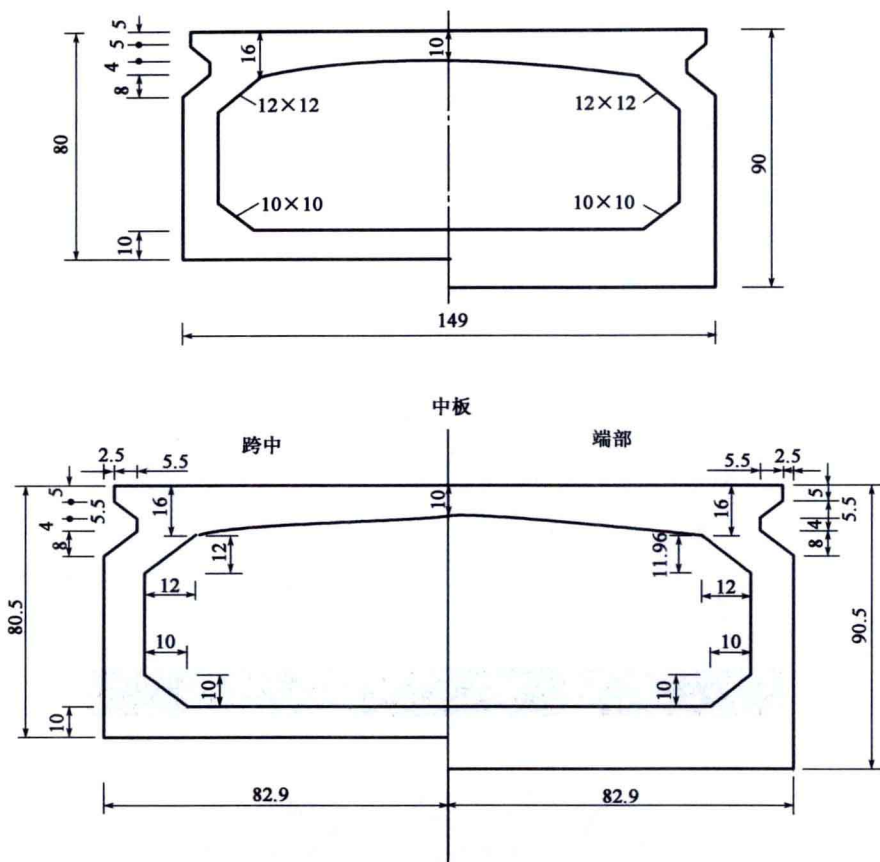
20m 跨空心板横断面图(尺寸单位:cm)
